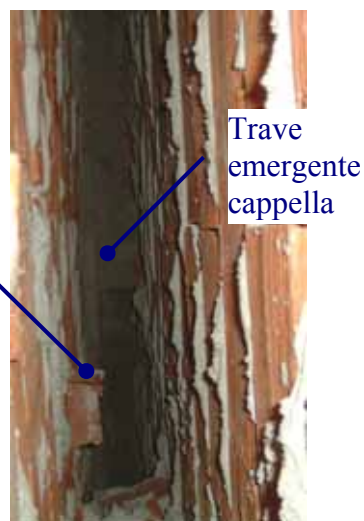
Piano terra cemento armato – appoggio travatura emergente della cappella su trave di bordo
